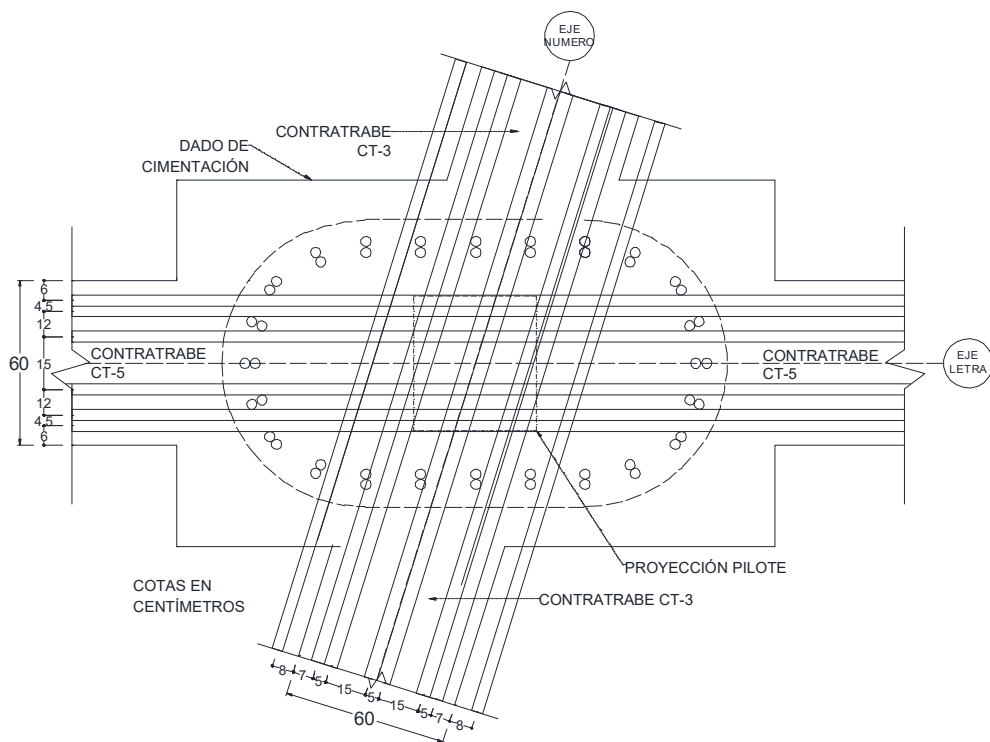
Vista en planta, conexión de dado de cimentación y contratrabe (Riobóo, 1995).
